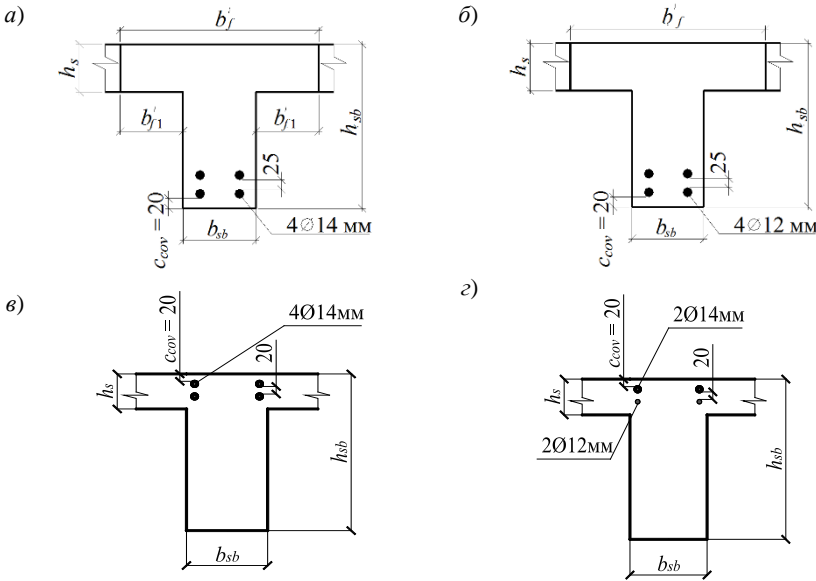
Расчетные сечения второстепенной балки с продольным армированием:
